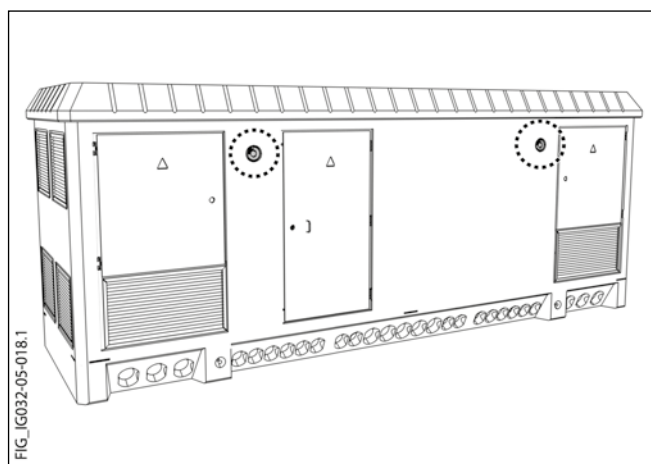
Vista exterior de la entrada auxiliar de acometida de baja tensión
